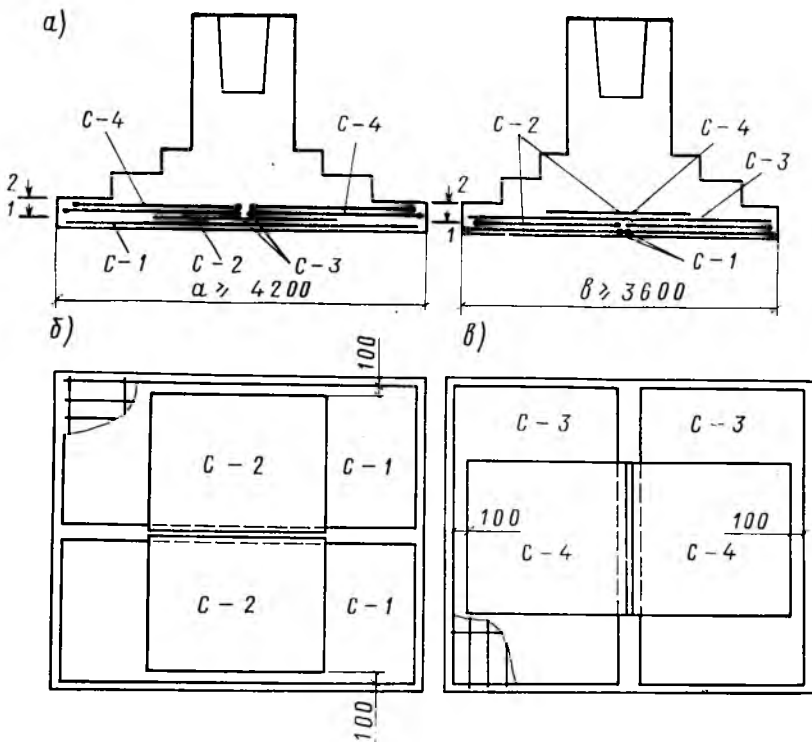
Армирование подошвы столбчатых фундаментов сварными сетками с рабочей арматурой в продольном направлении при наложении сетки на сетку (а) б — план раскладки 1-го слоя; в — то же, 2-го слоя
